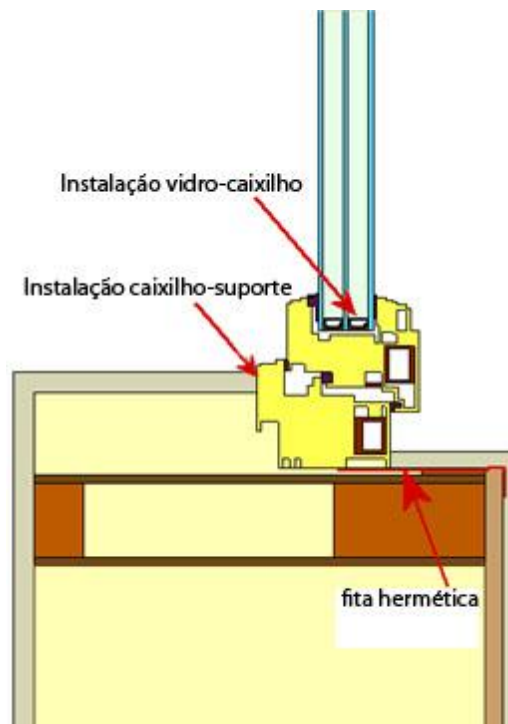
Pormenor da instalação de um envidraçado (adaptado: passipedia 2013)
